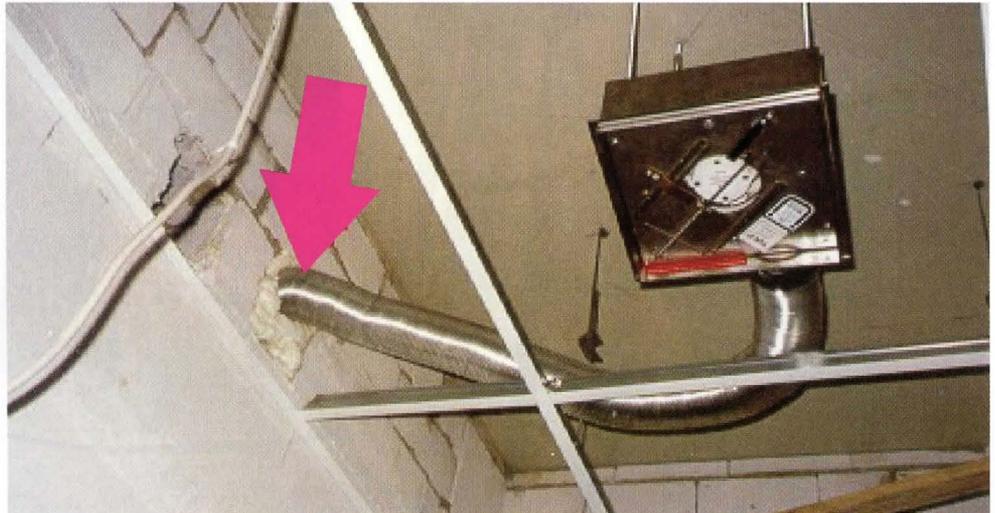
Nicht fachgerechter Einbau eines Einzellüftungsgerätes (Deckeneinbau) mit integrierter Brandschutzklappe. Der Einbau darf entsprechend dem Zulassungsbescheid (auch der M-LüRL) nur in einer F90/L90 Schachtwand erfolgen.
